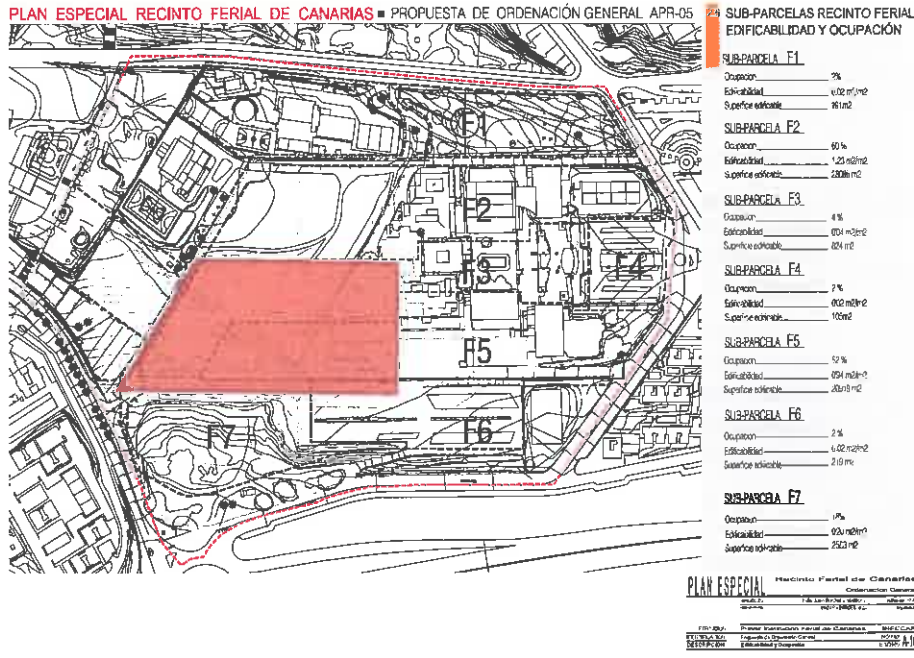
Plano de situación respecto a las sub-parcelas del Plan Especial del Recinto Ferial de Canarias
